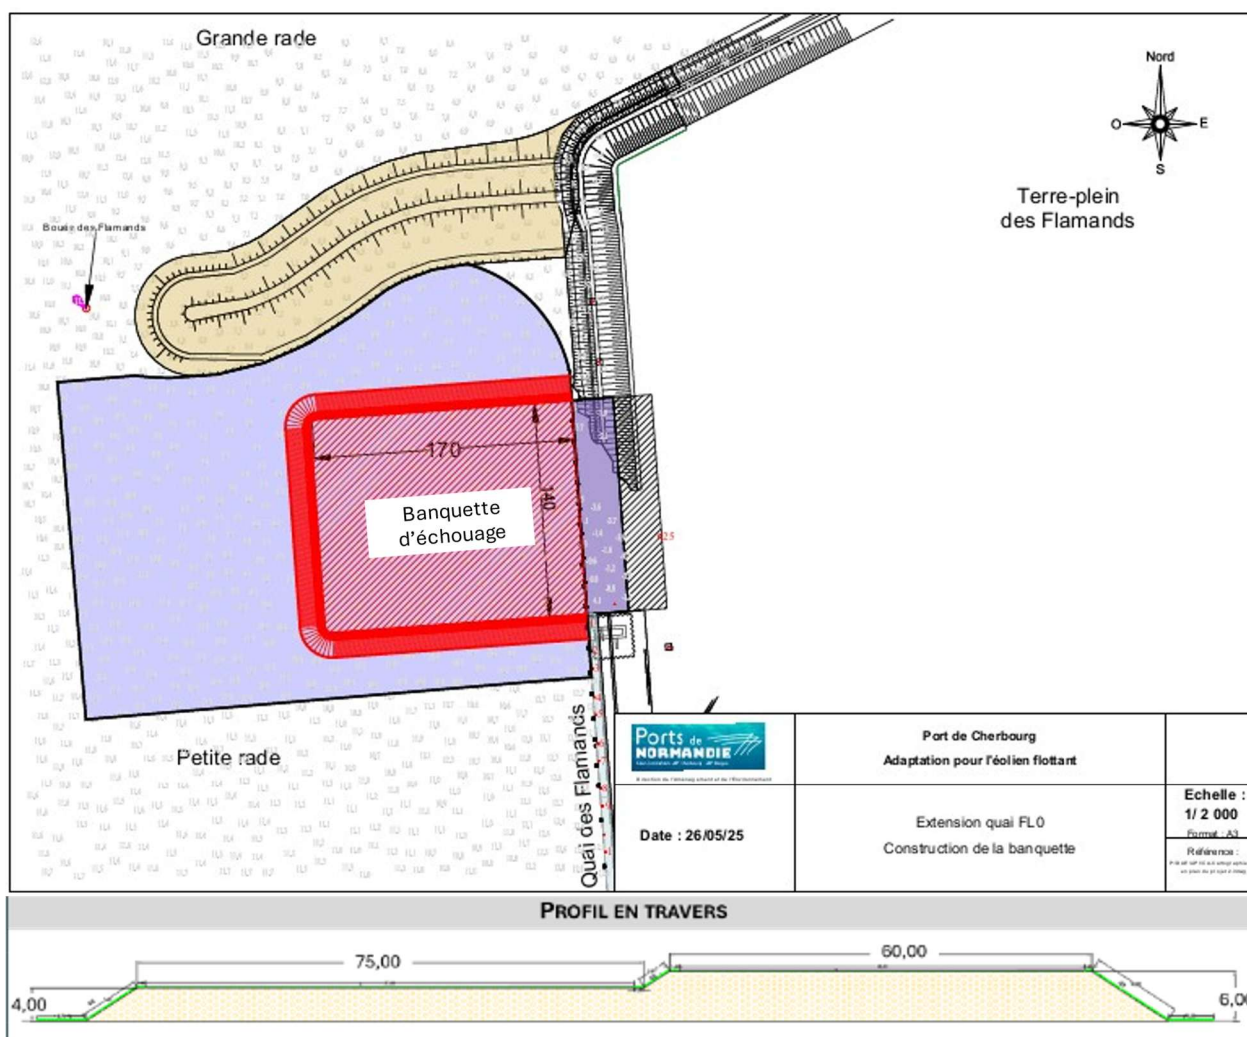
VUE EN PLAN DE L'EMPRISE DE LA BANQUETTE DE STABILISATION ET PROFIL EN TRAVERS
